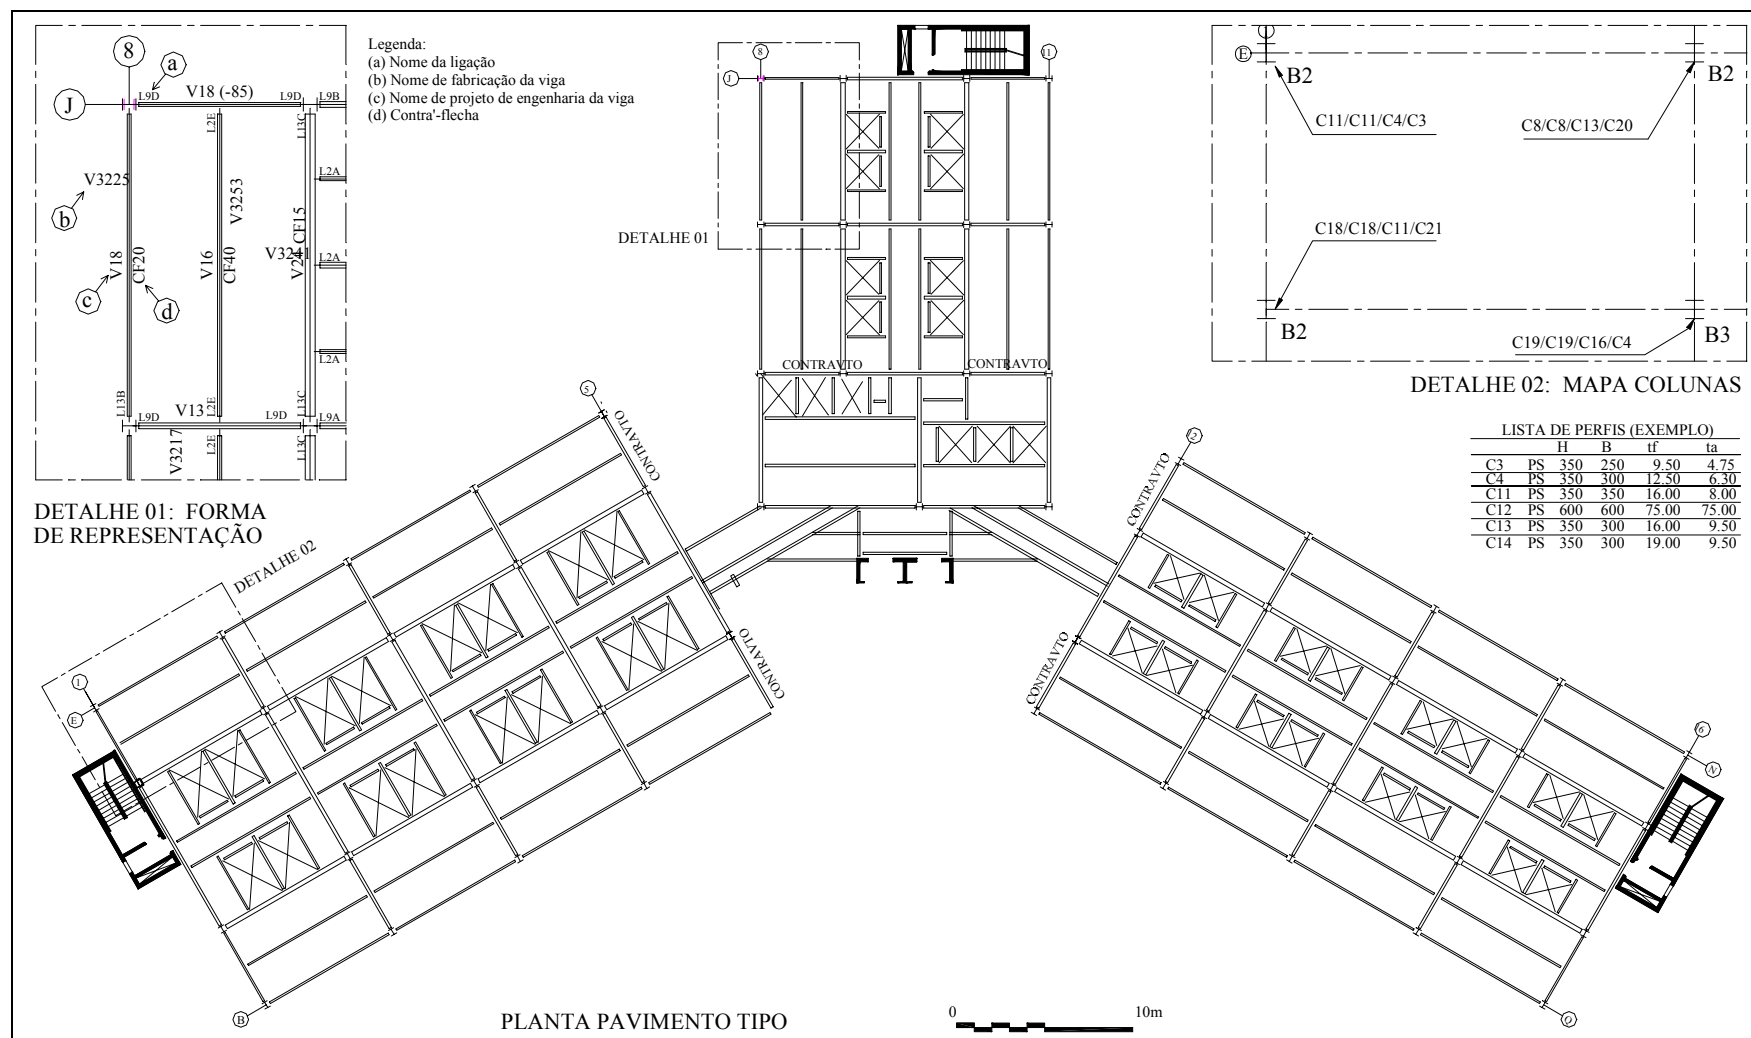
Solução estrutural do edifício E-1: esboço da planta do pavimento-tipo.
